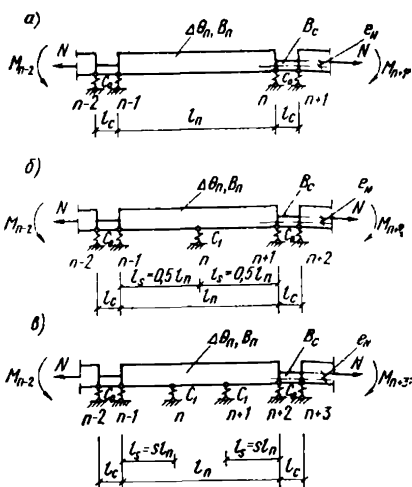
Схемы закрепления стеновых панелей с замоноличенными стыками к поперечным конструкциям (стенам, колоннам и т. п.) и перекрытиям
